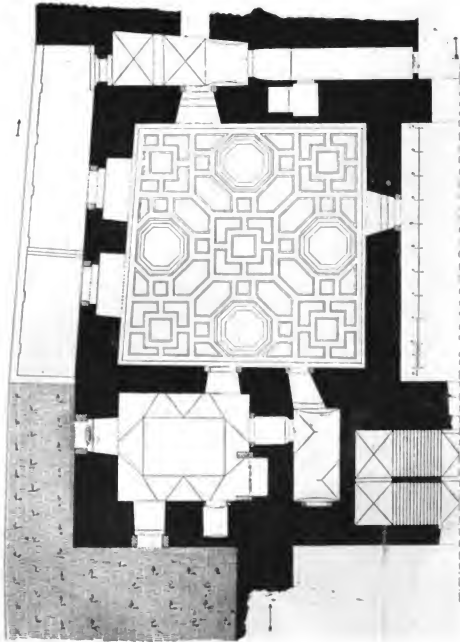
Bechin. Grundriss des Waffen- und Gerichtssaales.
